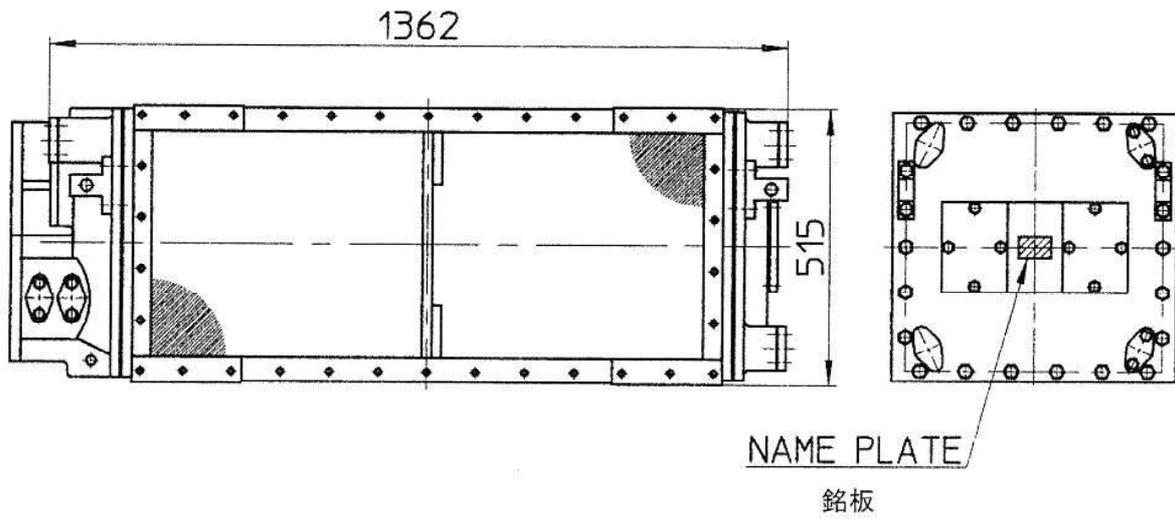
空気冷却器 Air cooler 形式 TYPE ;AHK155S
